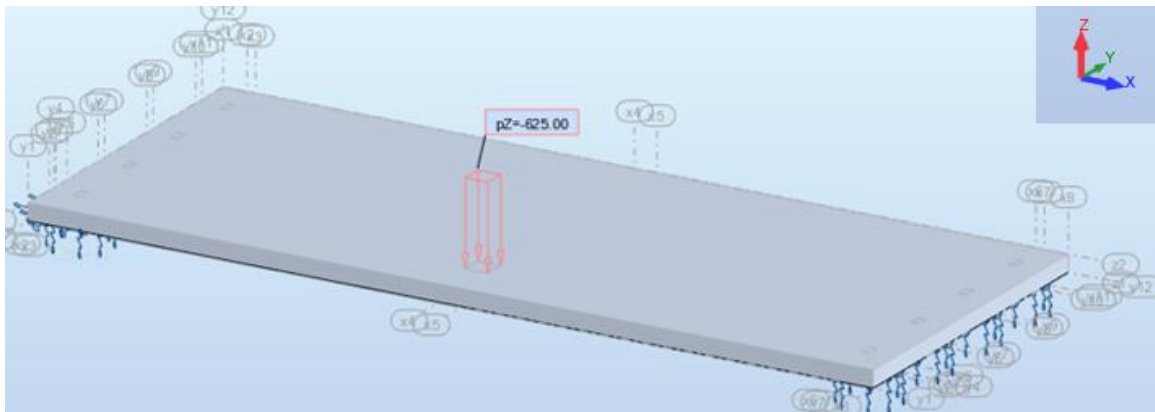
Desenvolvimento de modelo de laje de elementos sólidos com apoios planos: representação esquemática (Robot)
